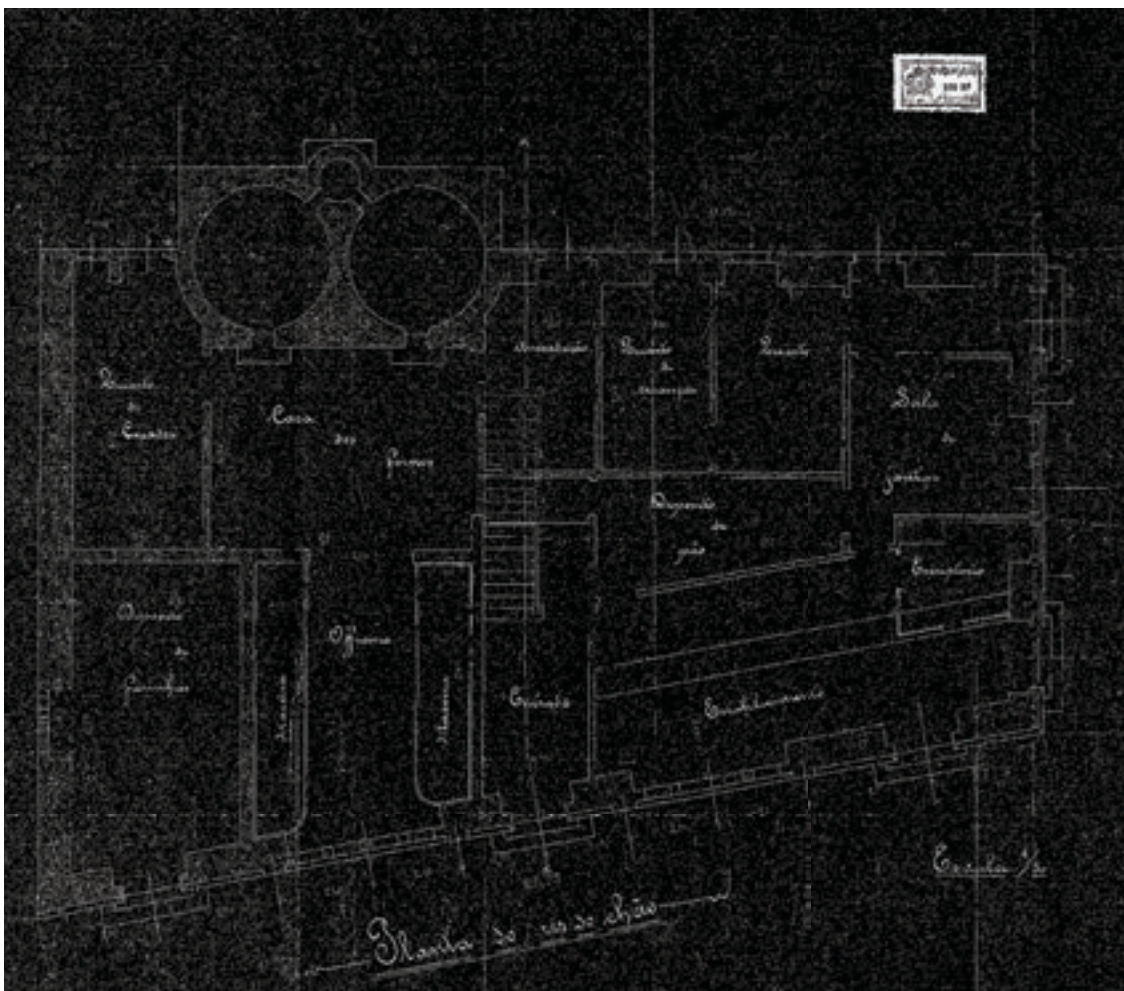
Planta do rés-do-chão do Edifício Garage: Largo Cónego Maia e Largo 5 de Outubro. (Romão, 1902-1908).
